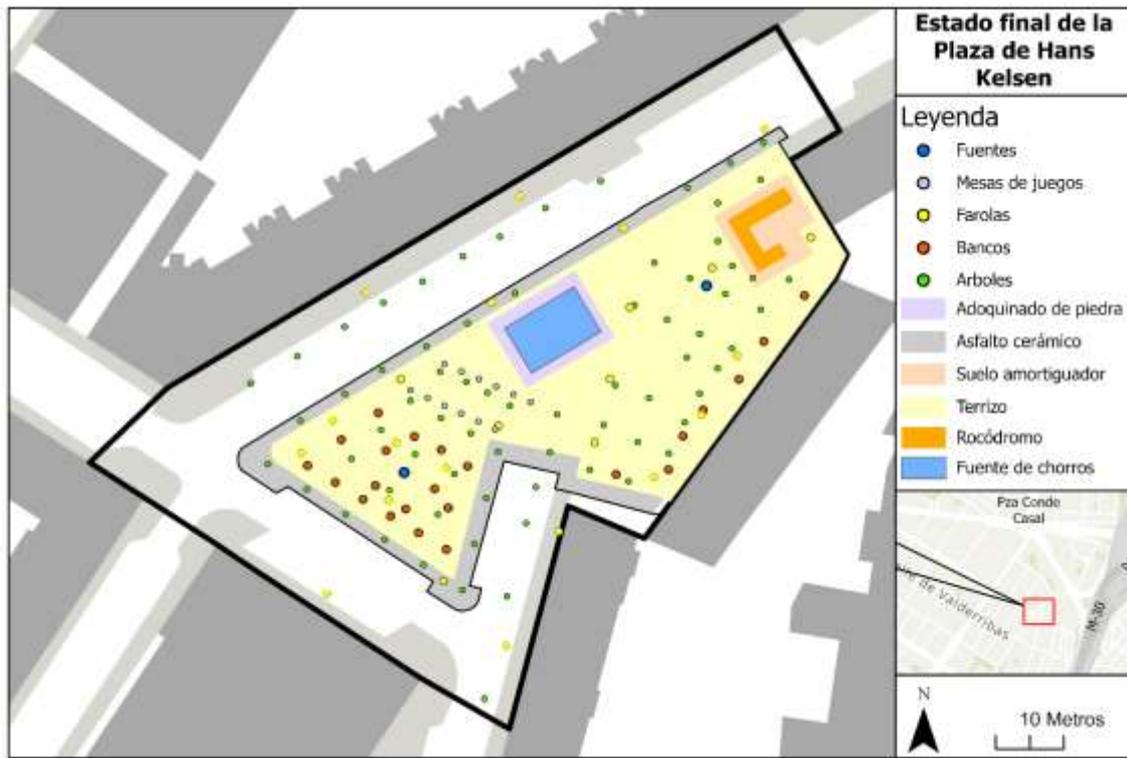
Plano del estado final de la Plaza de Hans Kelsen tras la intervención. Fuente: Elaboración propia
